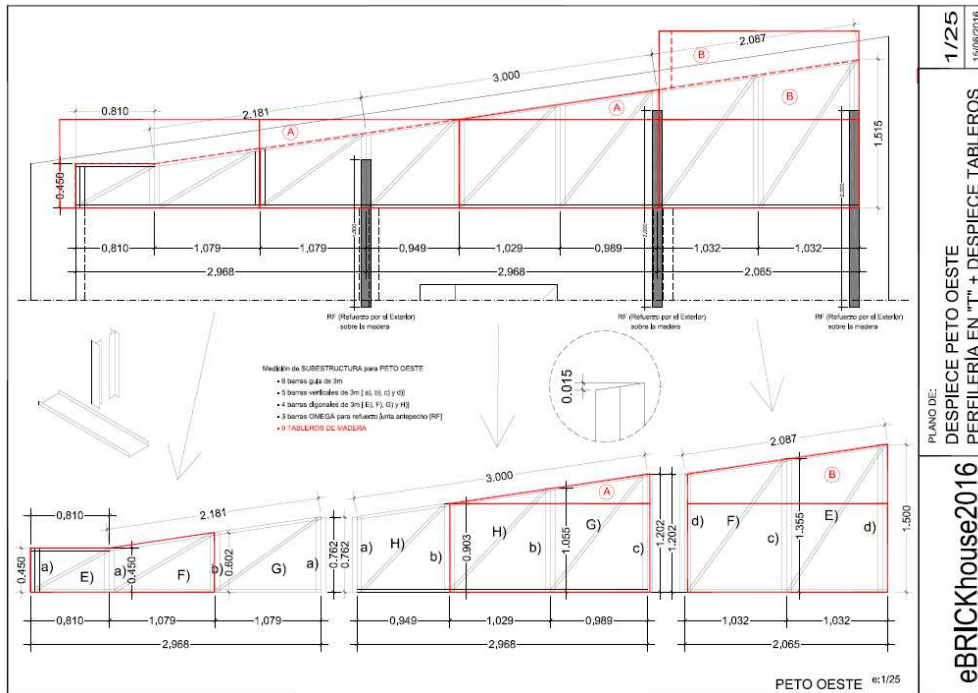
Diseño y despiece del nuevo antepecho fachada oeste de éBRICKhouse 2016 / [EP]
